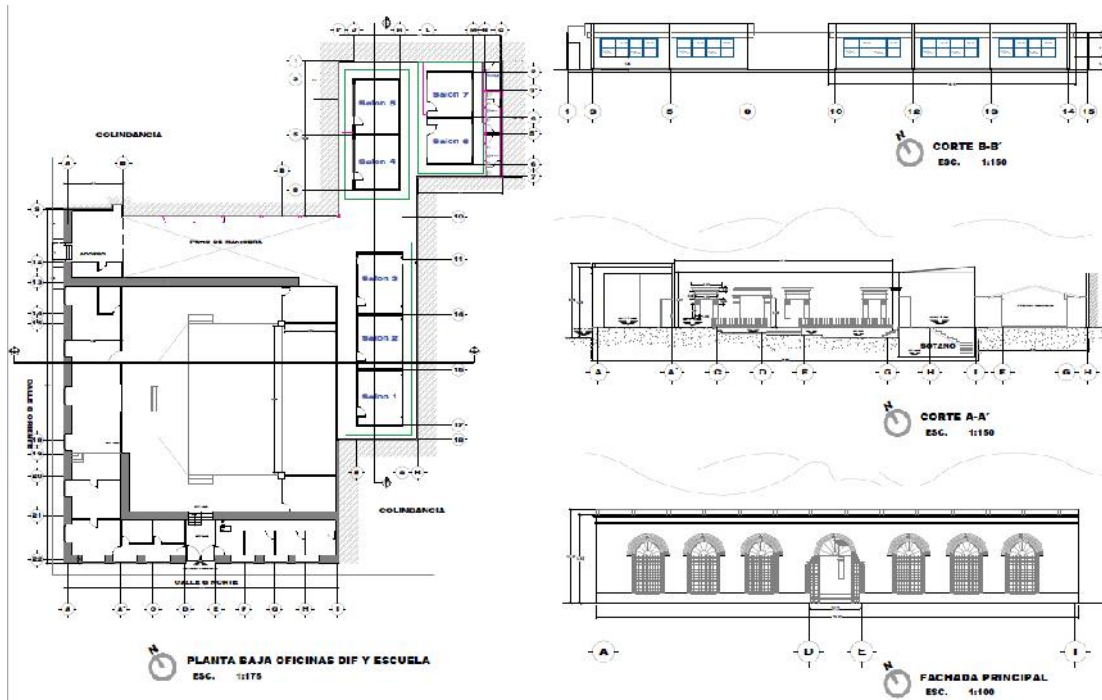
Plantas arquitectónicas corte y fachada estado actual. (Fuente: Propia).
